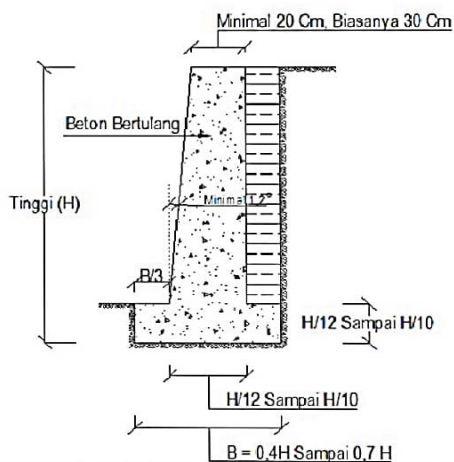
Dinding penahan tanah tipe gravitasi (gravity wall)
